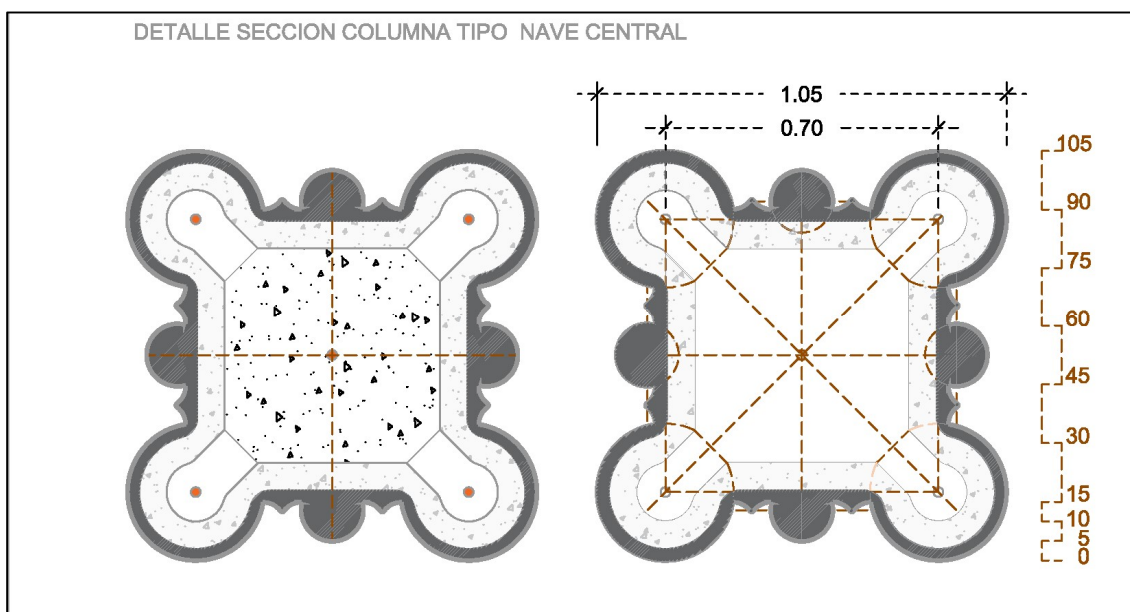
Detalle de la geometría de la columna tipo de las naves de la Catedral
